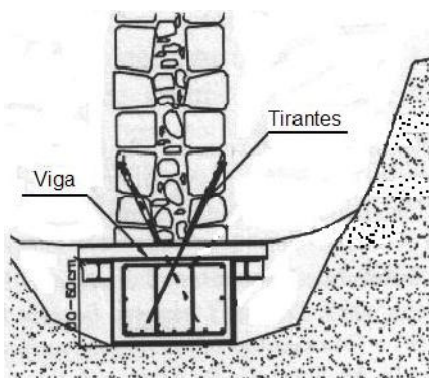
Esquema de execução de viga de fundação sobre parede de alvenaria [20]
